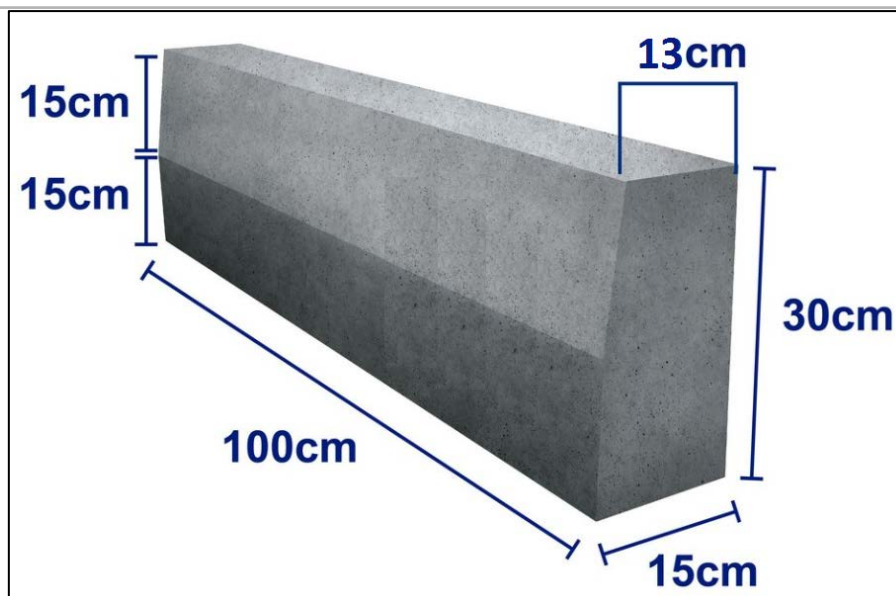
Modelo de Meio-fio de Concreto Pré-Fabricado
